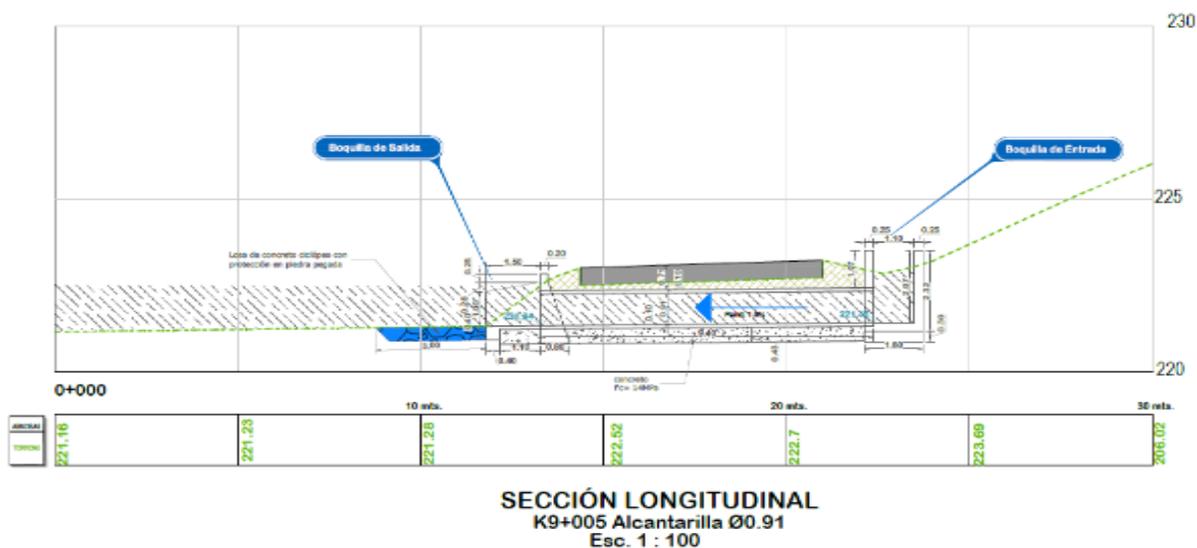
Sección Longitudinal Alcantarilla PR 9 + 05
